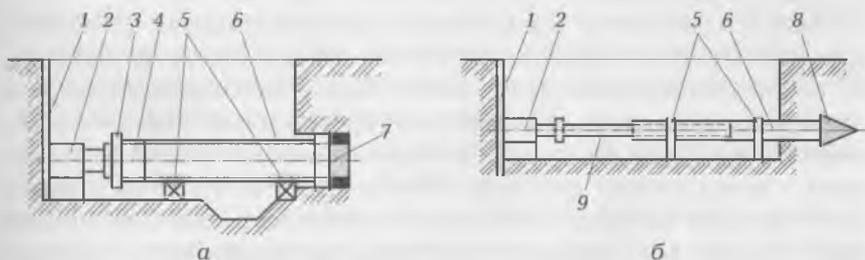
Схемы закрытых (бестраншейных) способов прокладки трубопроводов:
